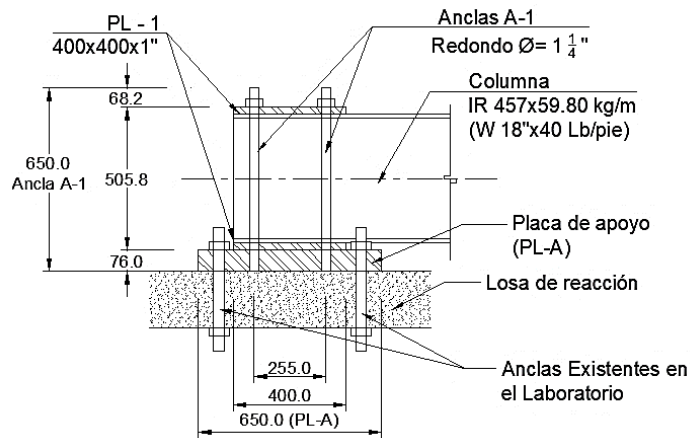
Detalle de los apoyos, vista lateral (Corte A-A). Cotas en milímetros
